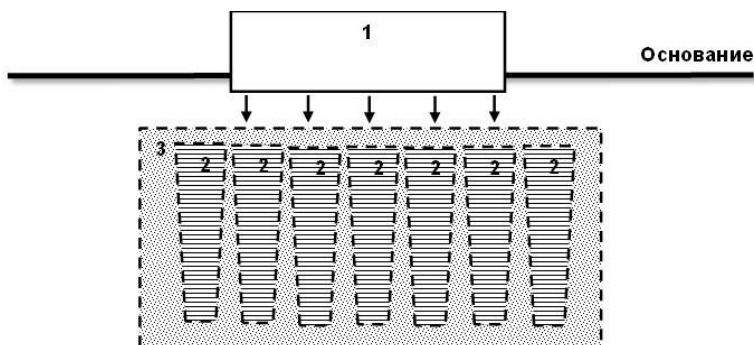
Схема образования фрагментарного техногенного геологического тела при термическом закреплении основания фундамента: 1 – фундамент; 2 – столбы обжига грунта; 3 – фрагментарное тело
